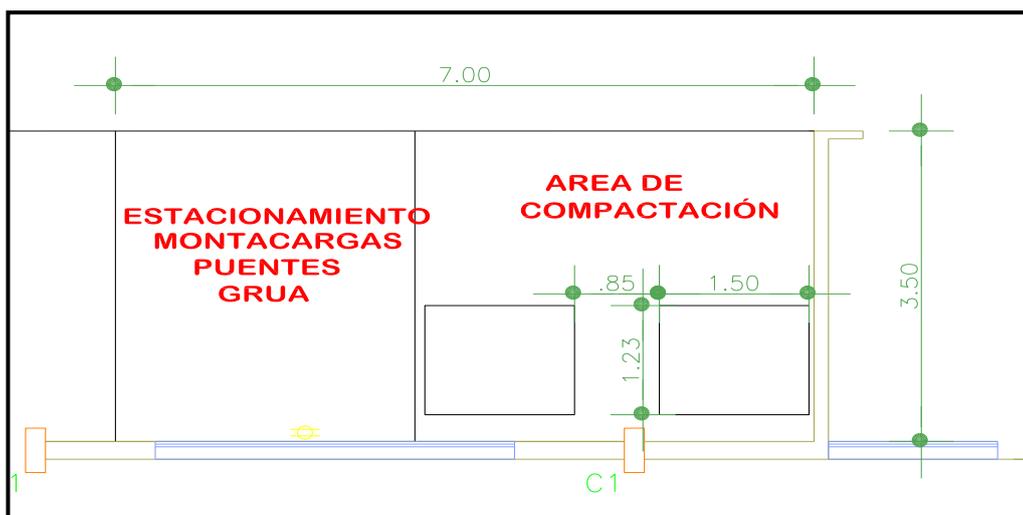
Vista arquitectónica específica del área de compactación de la planta de reciclaje.
